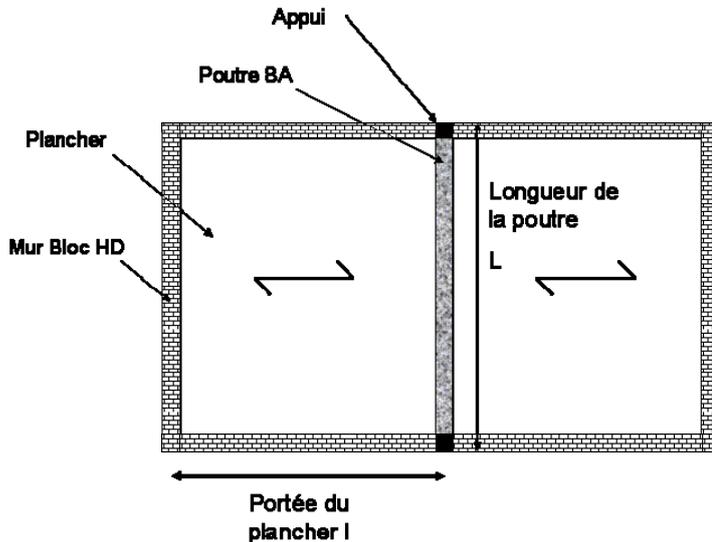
Schéma de chargement d'une poutre reprenant deux planchers
